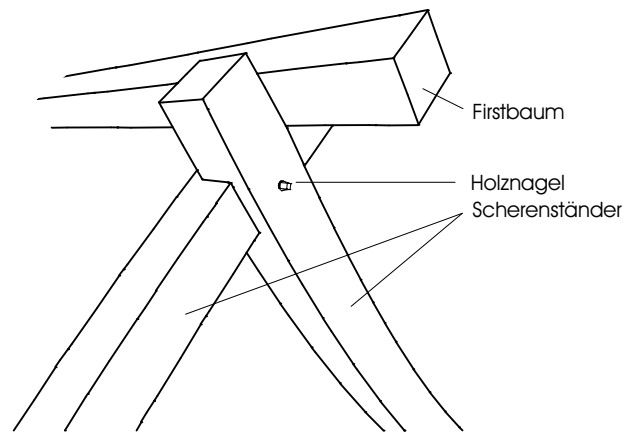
| Detail Scherendachstuhl: zwei sich kreuzende Scherenständer tragen gemeinsam den Firstbaum
